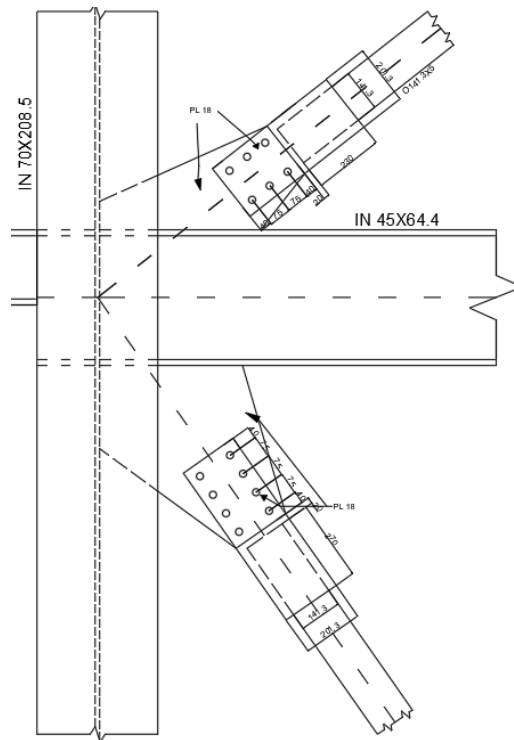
Detalle disposición X perfil O 141.3x5 conexión con viga.
